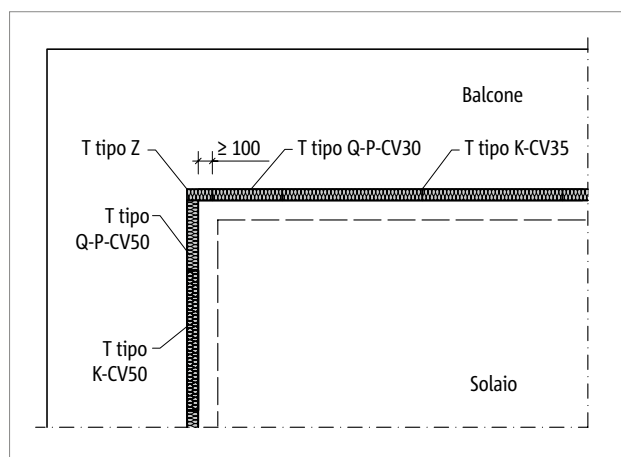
Schöck Isokorb® T tipo Q-P, K: angolo esterno; pianta con balcone a sbalzo (inserimento ≥ 100 mm, misurato dal lato interno)
